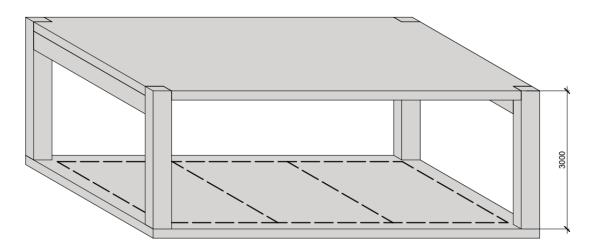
ЗД-вид типовой ячейки высотой 3 м
